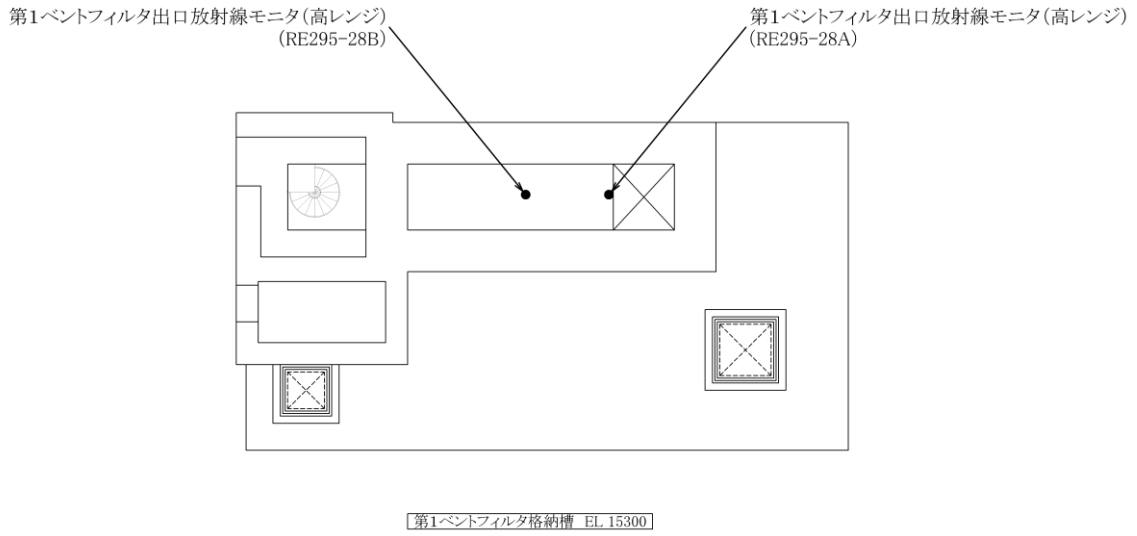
機器配置図 (第1ベントフィルタ格納槽) (2/3)
